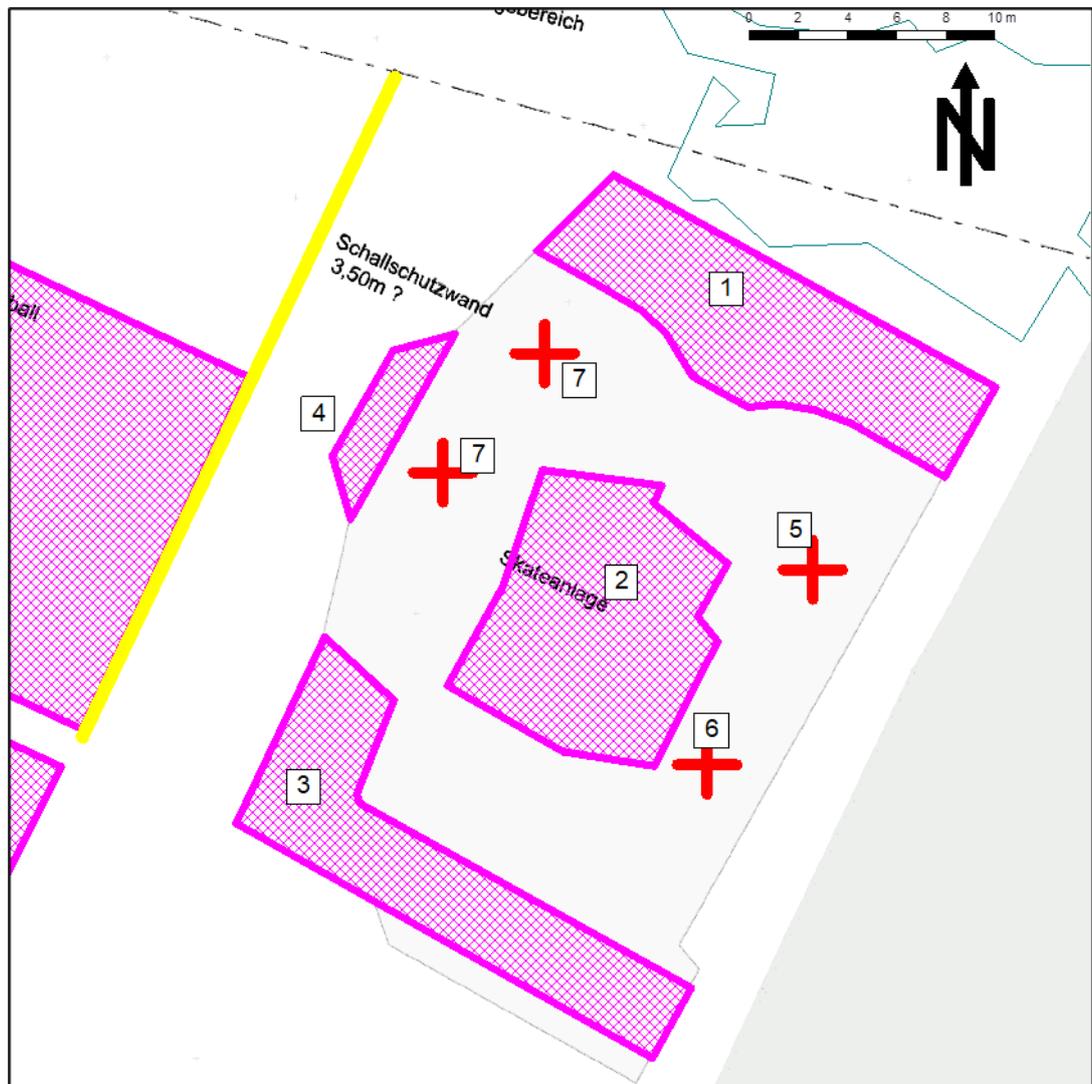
Plangebiet – Detailplan Skateanlage.
